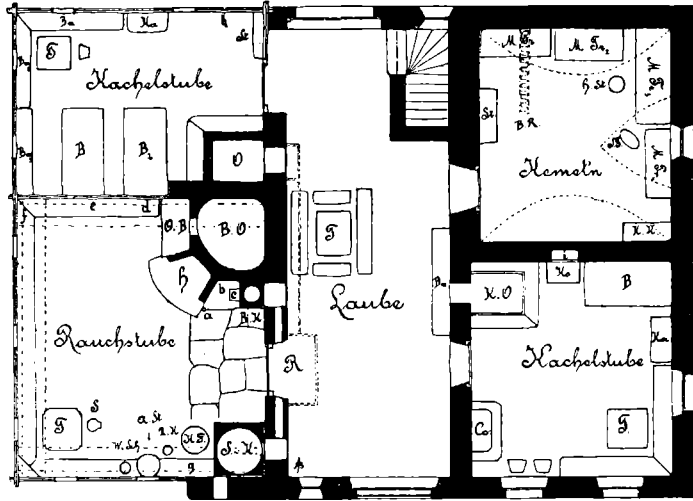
Grundriss des Erdgeschosses des Bartelbauer-Hauses.
